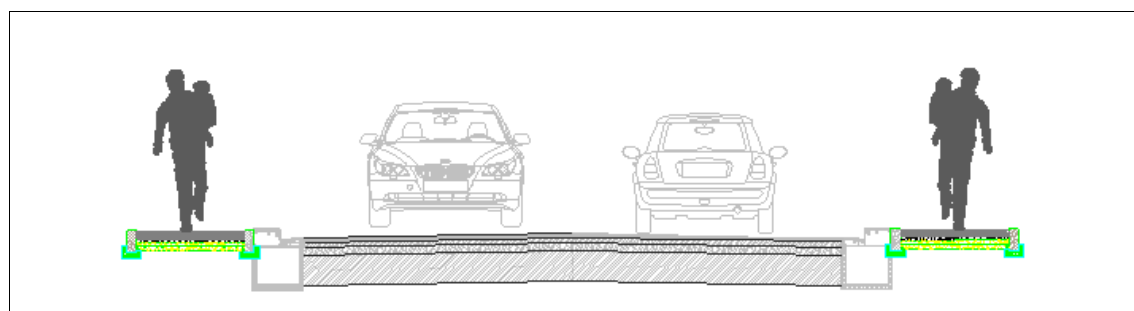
Sezione asse perimetrale ovest - tratta sud
